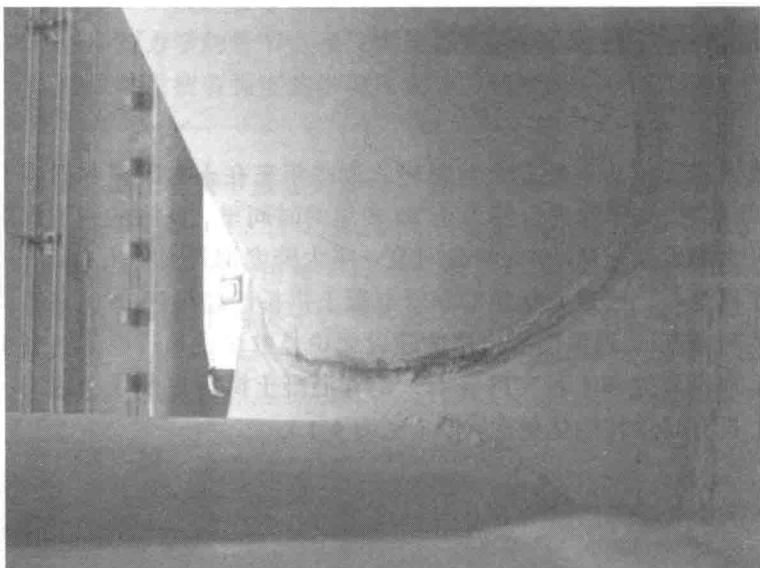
钢管混凝土拱桥管节点相贯线焊缝开裂
